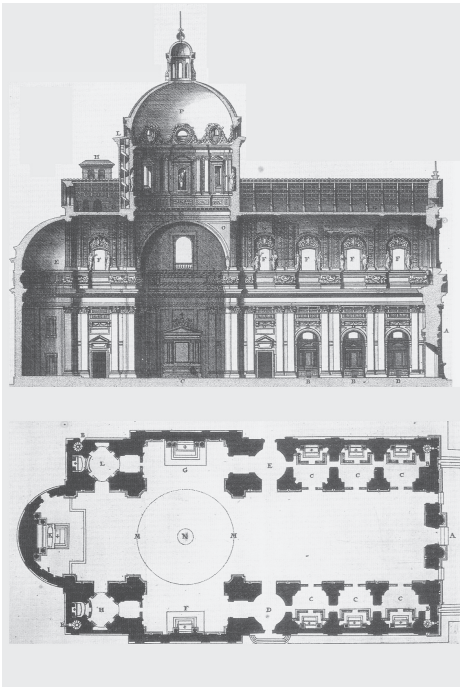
Gesù: plan et coupe. Muralité de la nef
